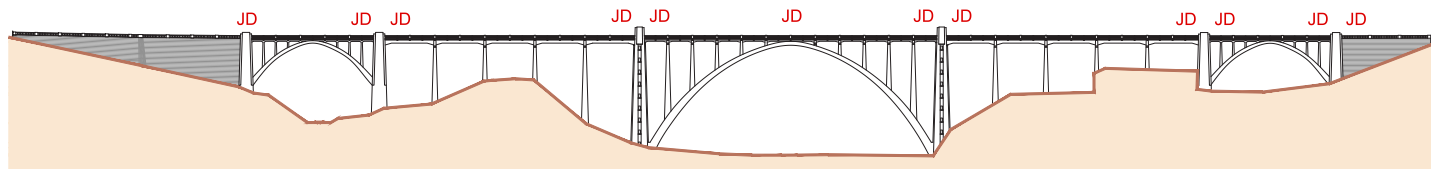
Localização das juntas de dilatação. Location of the expansion joints.
